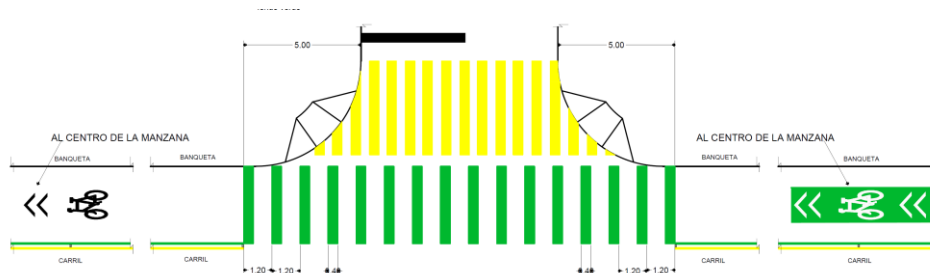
Detalle de señalamiento horizontal Tipo 2, manzanas menores a 100m.
